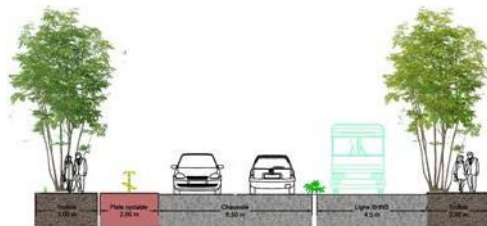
coupe schématique sur la rue Kasri après les interventions
